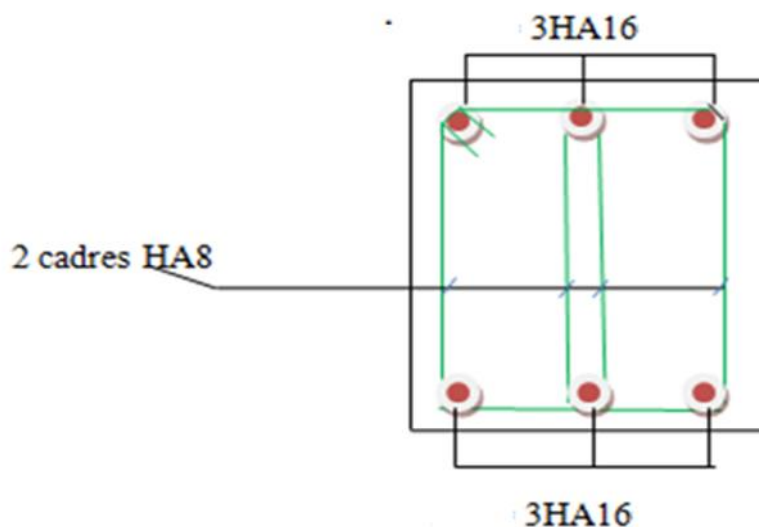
Coupe vertical en travée de poutres principales adhérentes aux voiles
